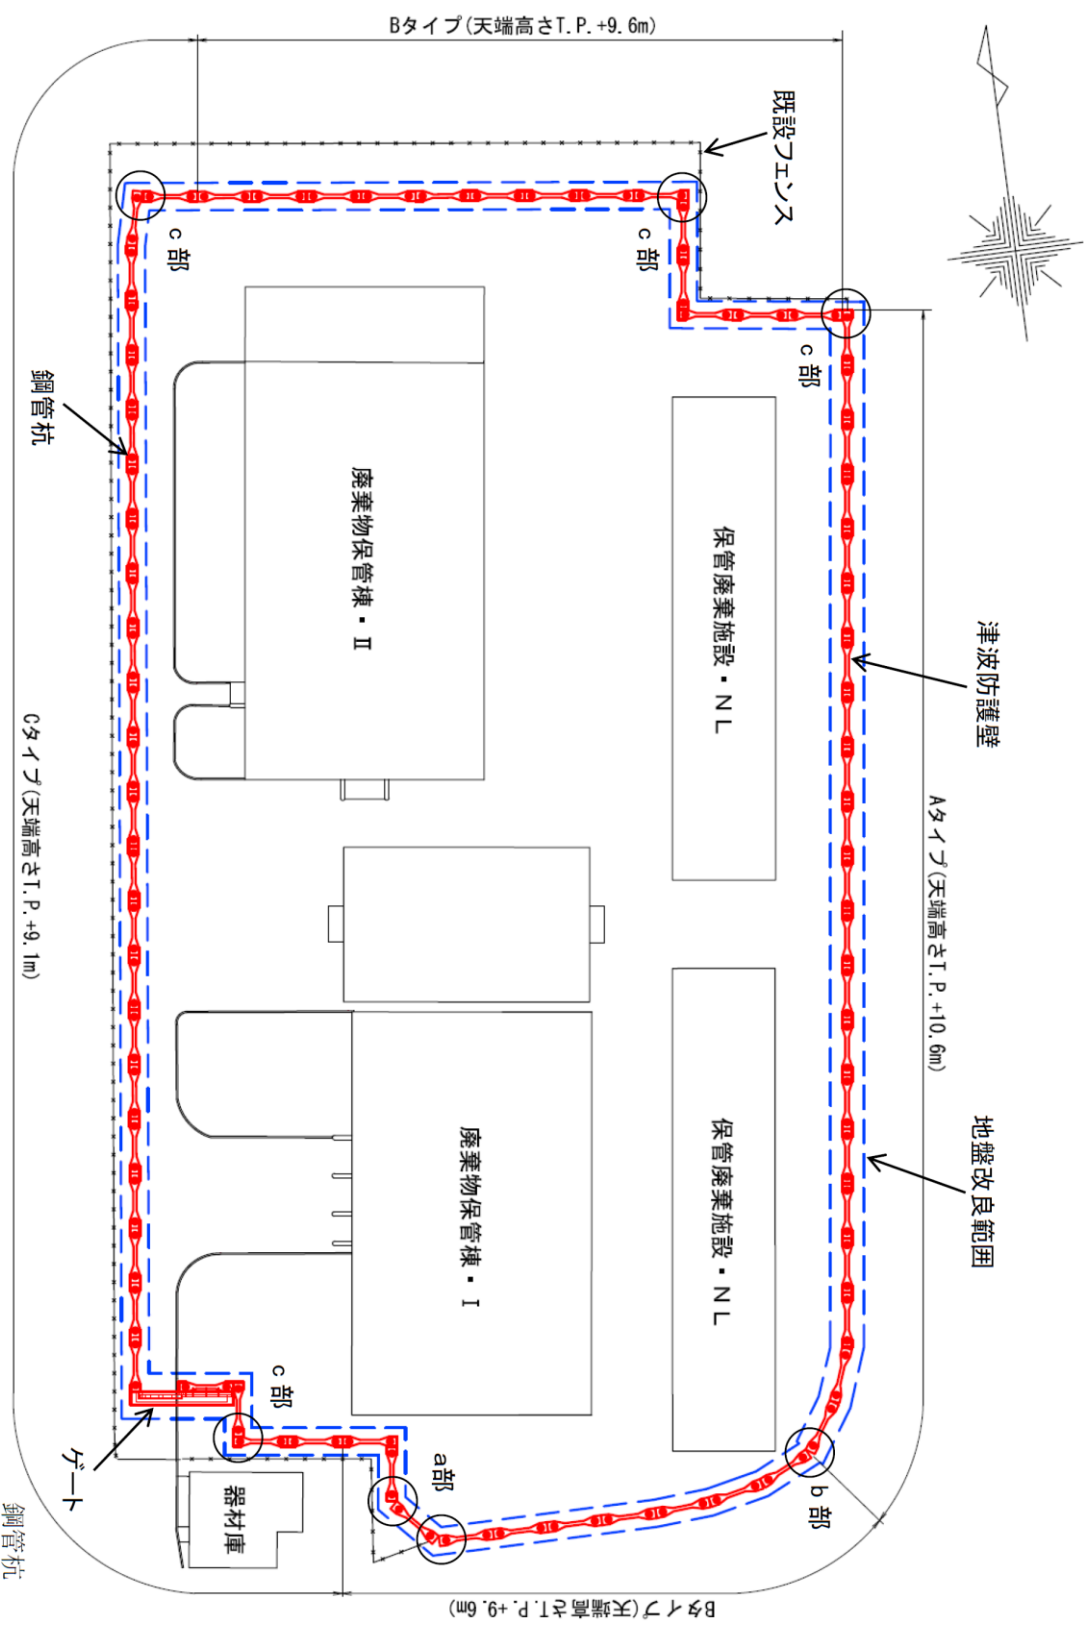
津波防護壁配置図 (第2保管廃棄施設)
